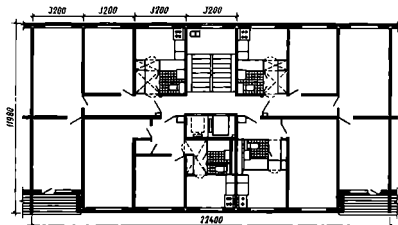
Первый крупнопанельный 12-этажный жилой дом на ул. Чкалова в Москве. План секции
